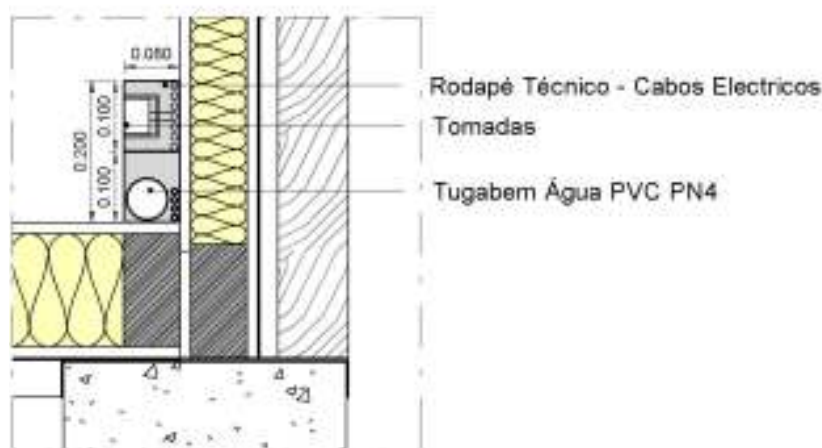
Pormenor do rodapé técnico para passagem da tubagem de eletricidade e alimentações.
